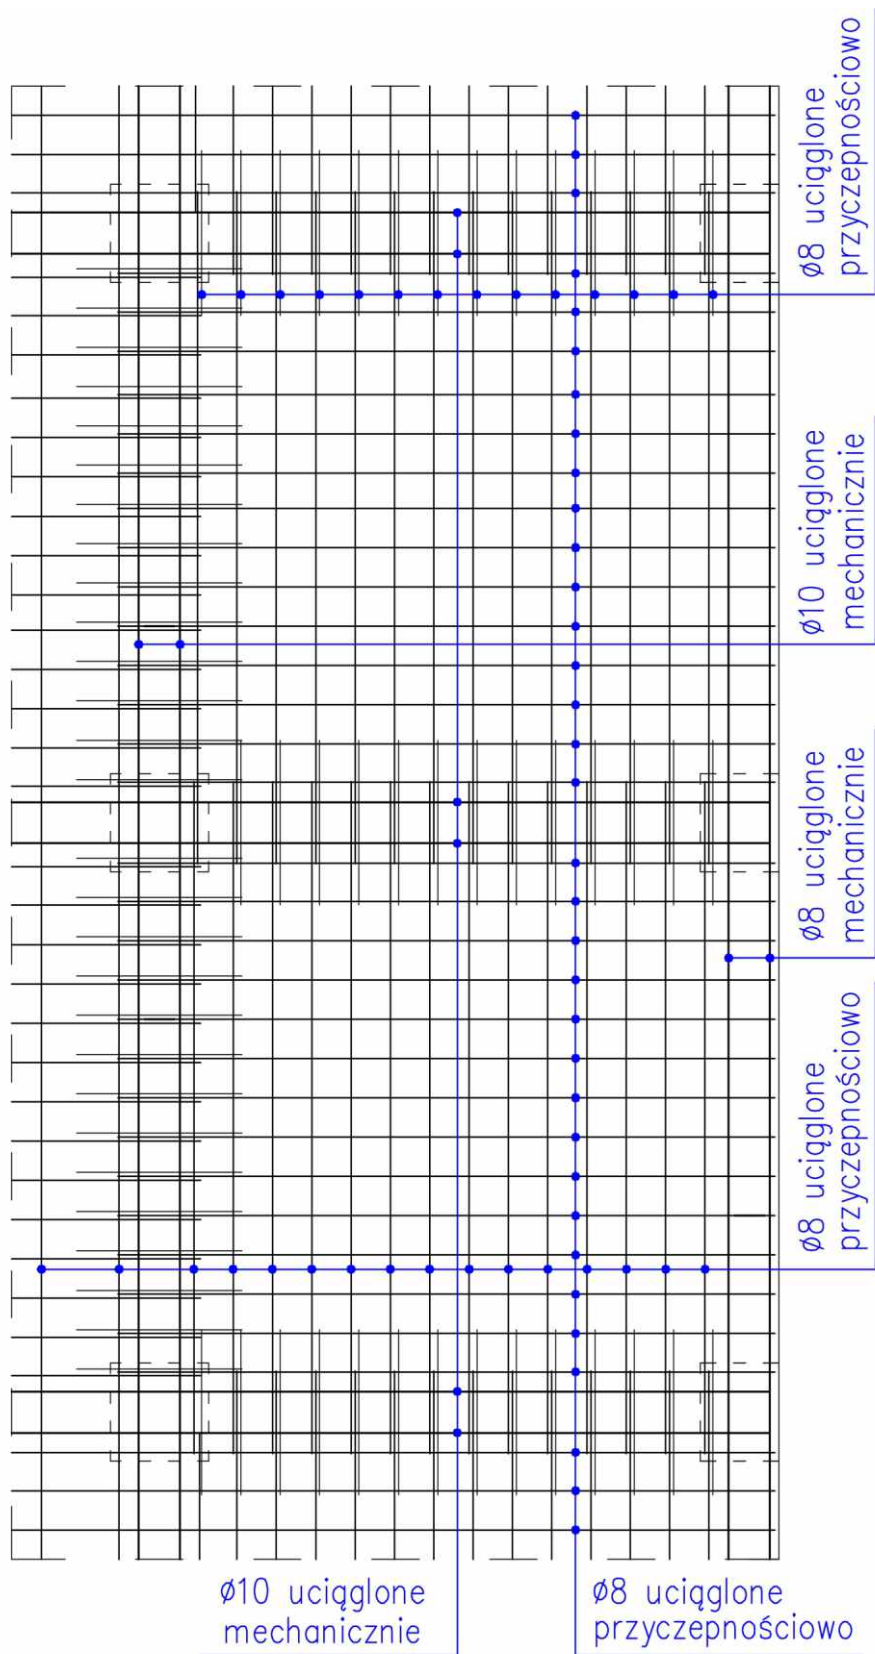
Zaprojektowane rozmieszczenie wkładek zbrojenia górnego (strefa wewnętrzna)
